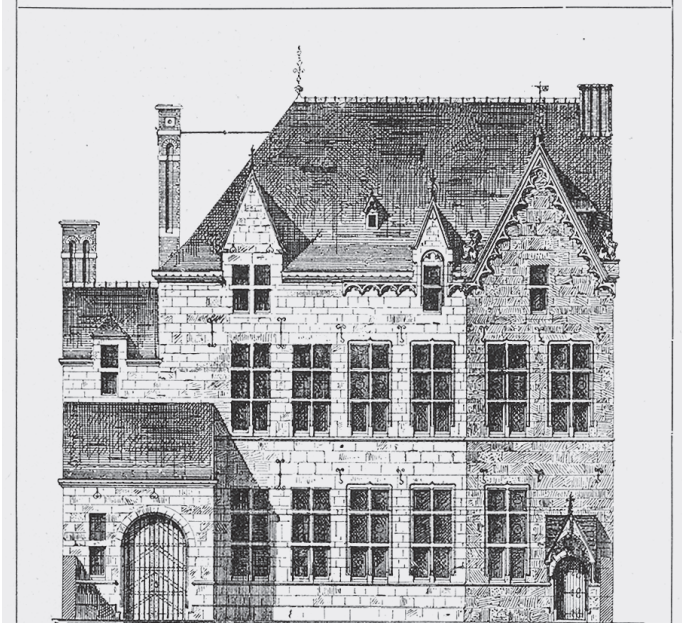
Haus Place St. Pierre. Vorderansicht. (f.)
